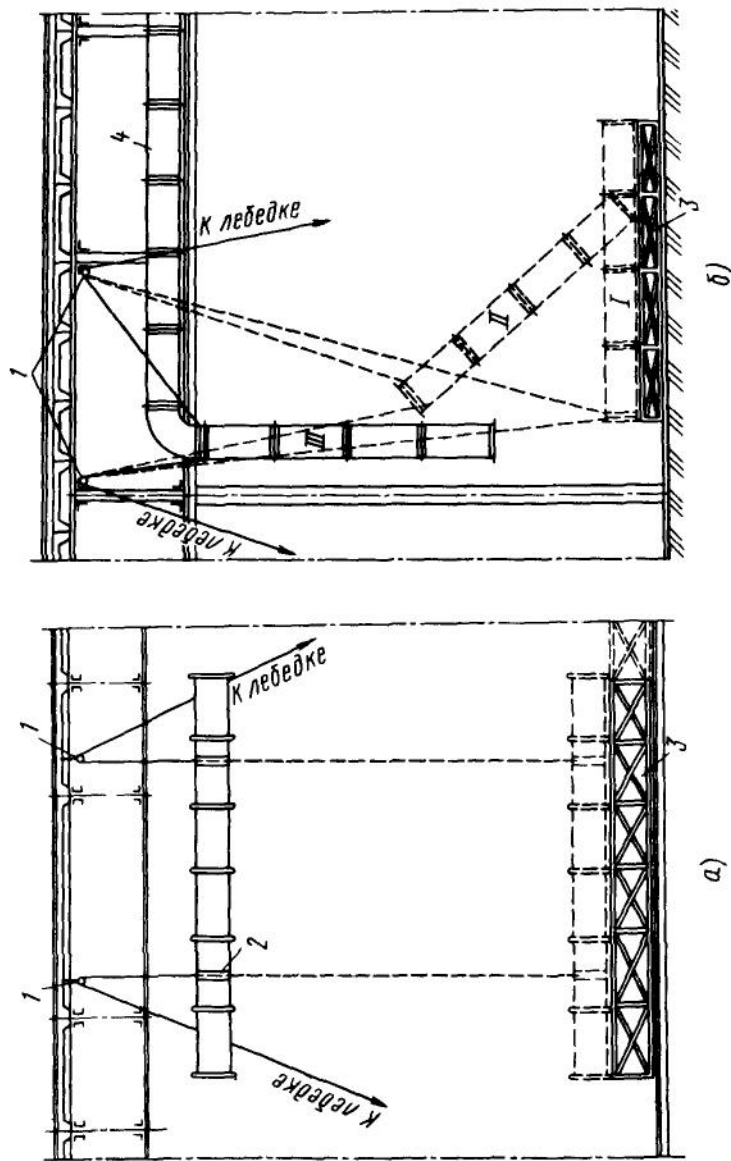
Монтаж круглых воздуховодов, соединяемых на бандажах:
